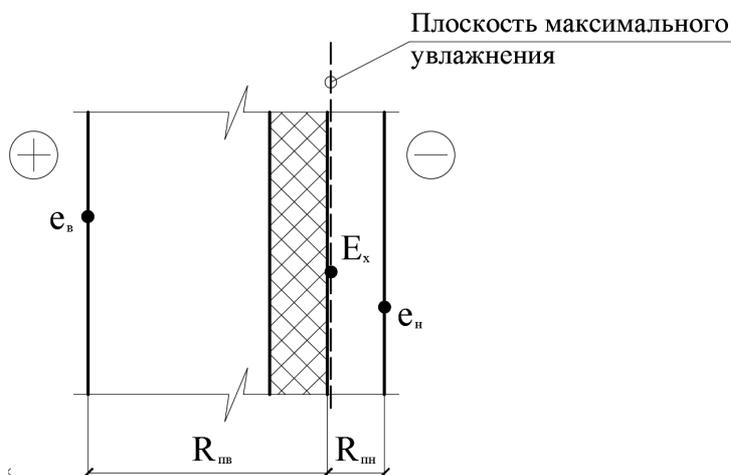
К расчету защиты от переувлажнения конструкции наружной стены
